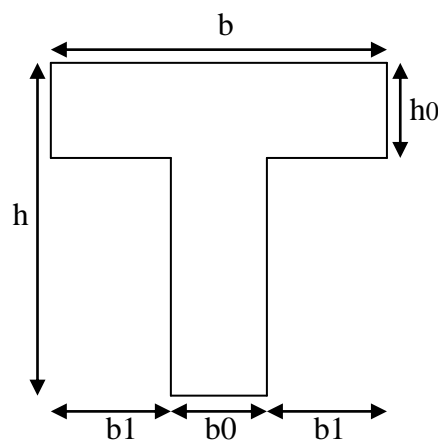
Schéma d'une poutrelle de RDC jusqu'au 2^{ème} étage
